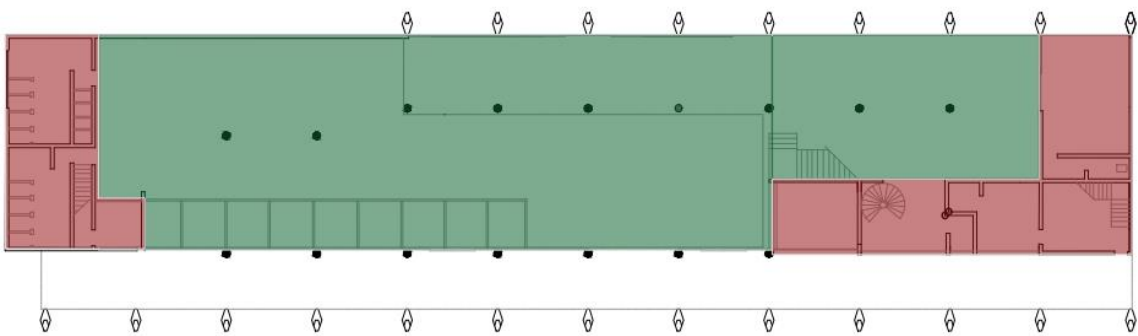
s.d. / Esquema da planta do pavimento térreo do Terminal Rodoviário Luís Garcia ©DER. Planta modificada pela autora.
